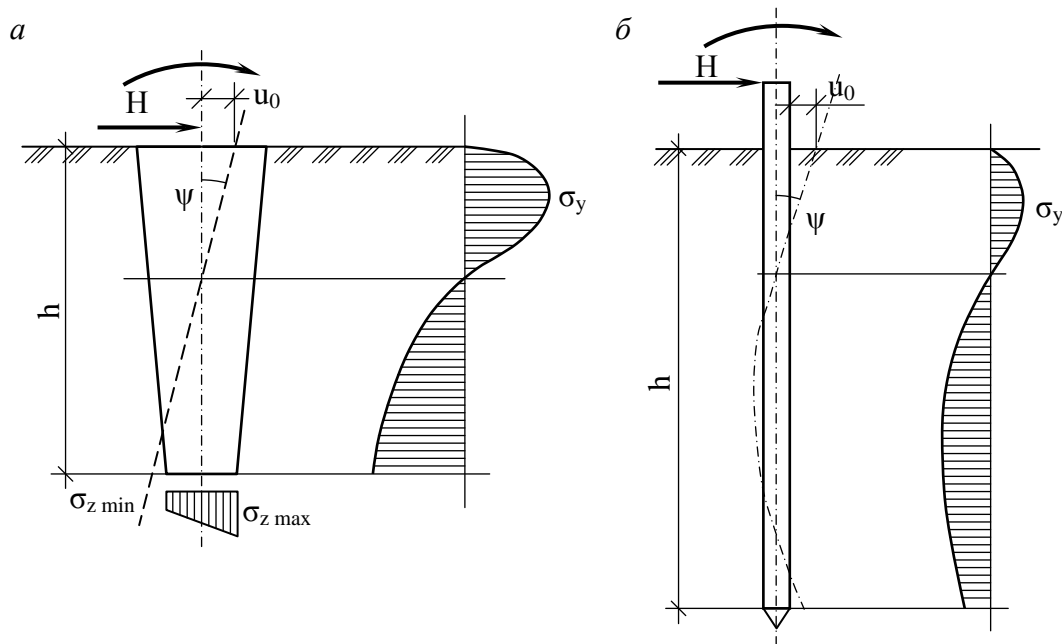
Схеми роботи фундаментів, споруджуваних без виймання ґрунту, на дію горизонтального навантаження:
